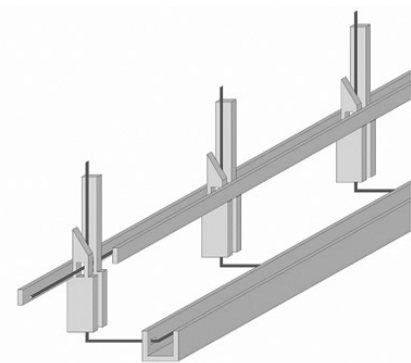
Passagem de tubulações entre pilares e vigas até a galeria.
